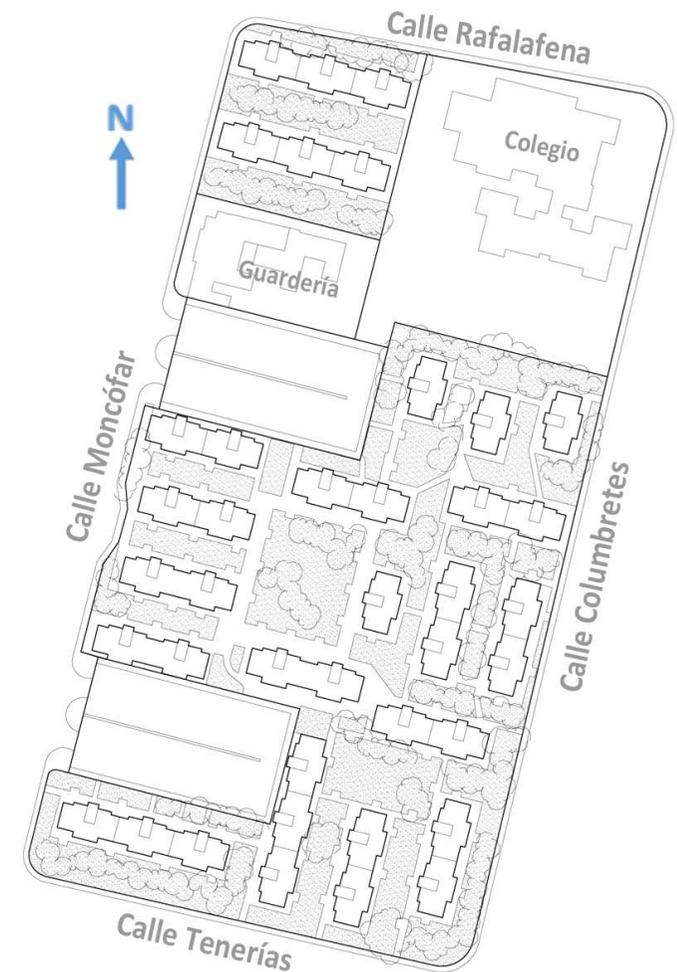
Plano de distribución de la manzana del Grupo Rafalafena. Fuente: Elaboración propia sobre PGOU de Castellón.
